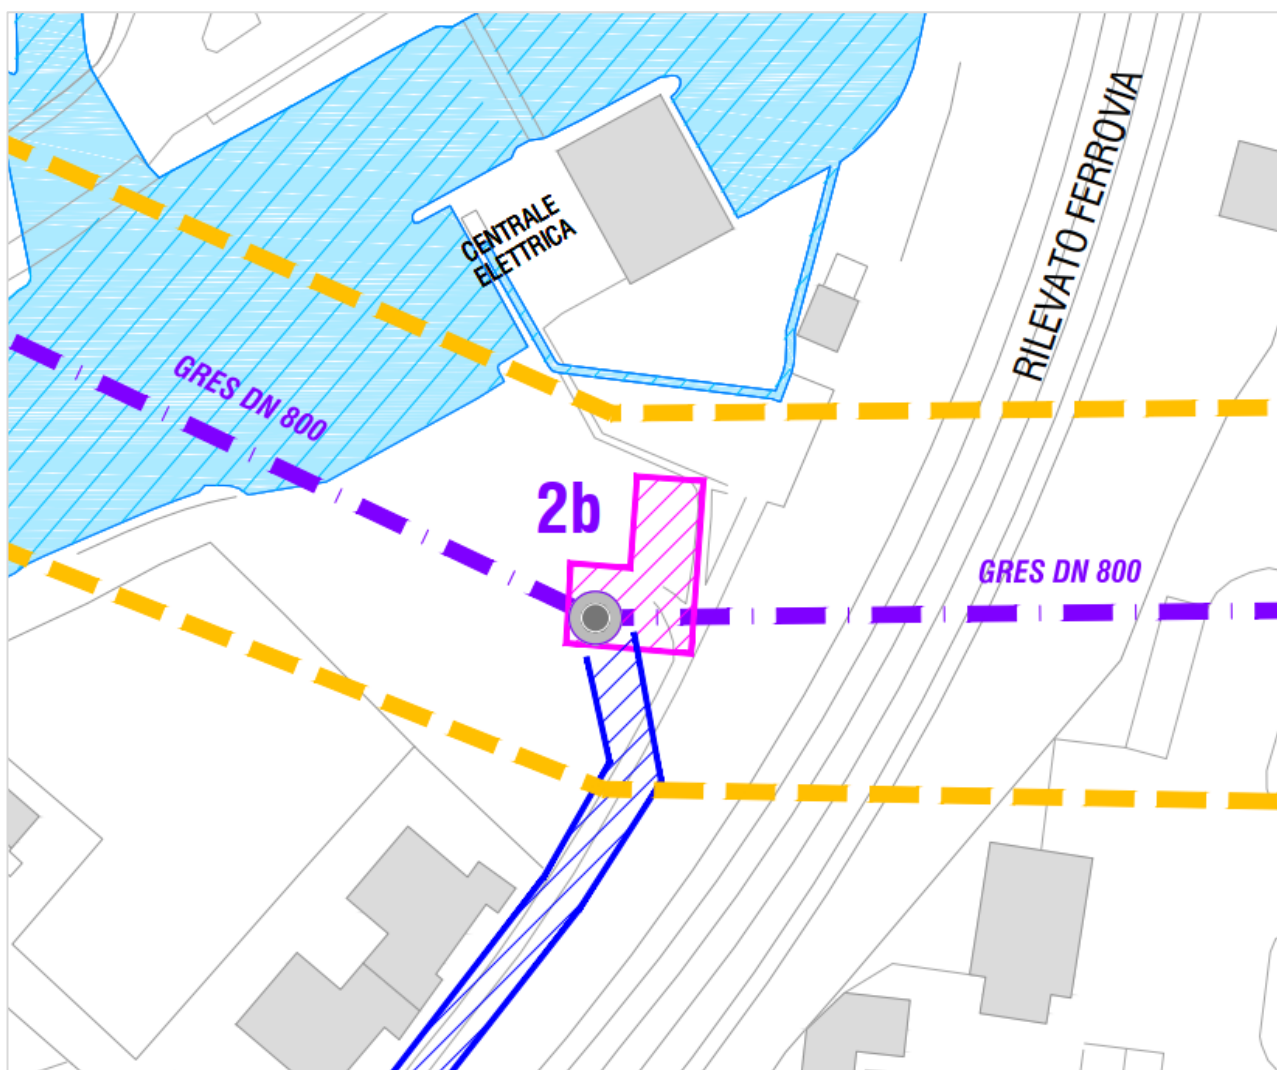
I : Inquadramento planimetrico area cantiere pozzo S2b
